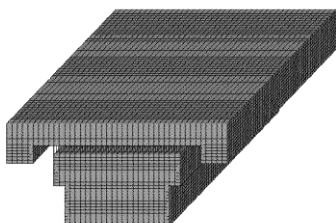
Фрагмент сейсмоізоляційного фундаменту
